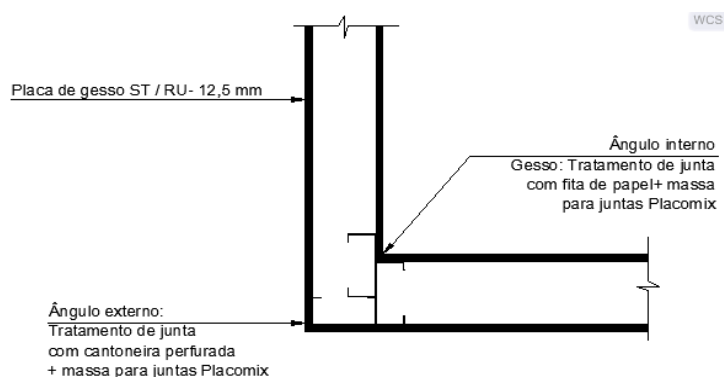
Encontro interno e externo entre chapas de gesso para drywall.
